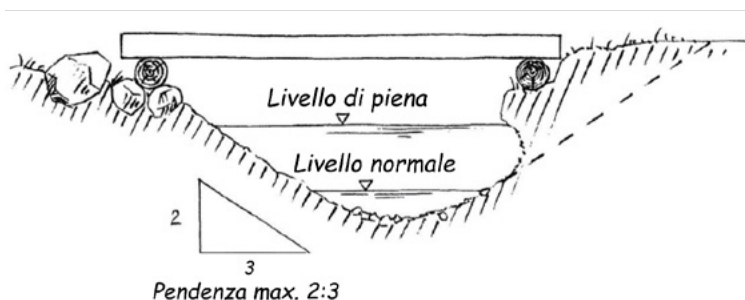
Schizzo di spalle ben posizionate (USTRA)
